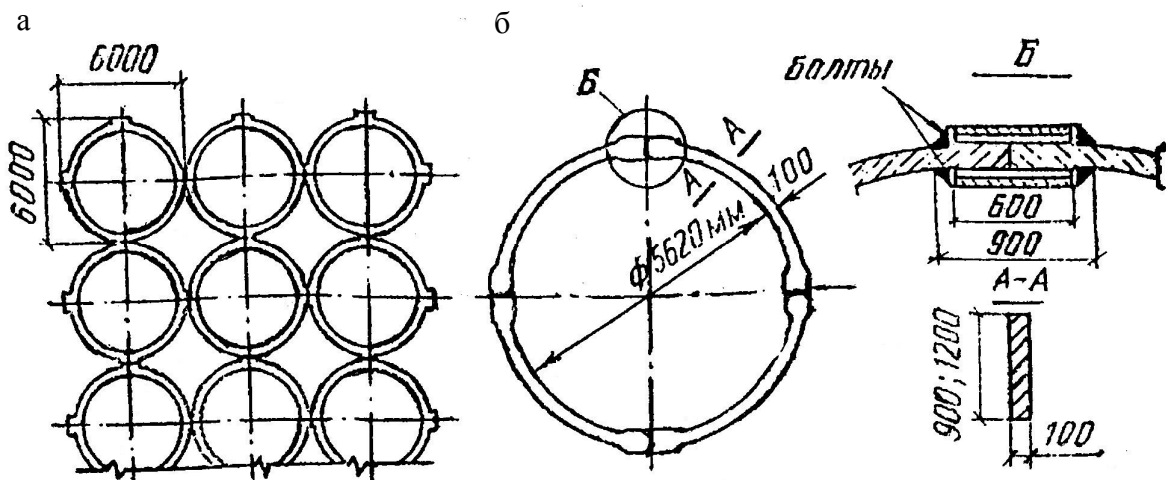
Сборные силосные корпуса с цилиндрическими силосами: а – фрагмент плана корпуса; б – конструктивная схема яруса
